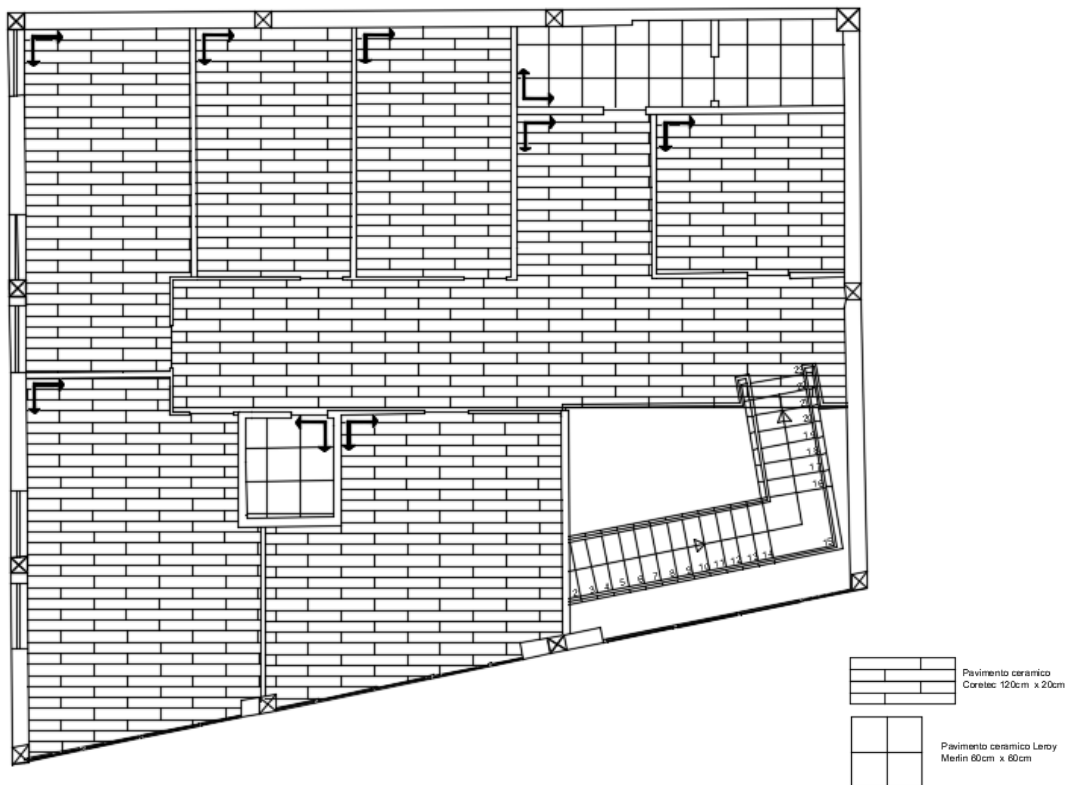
Planta de pavimentos, piso 1. Fonte: Ana Cândido.
